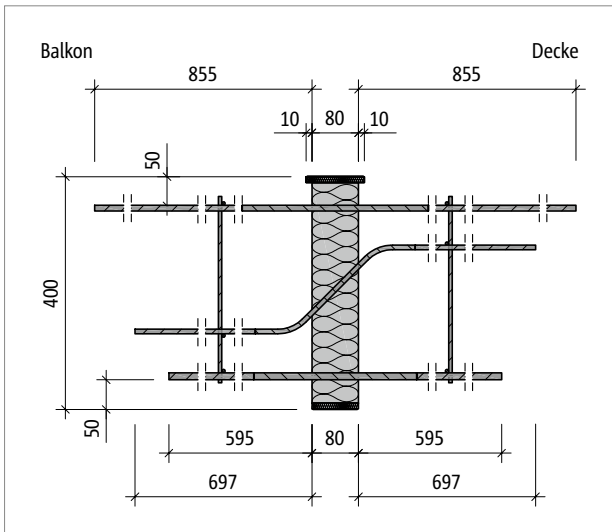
Schöck Isokorb® T Typ B-M1: Produktschnitt
